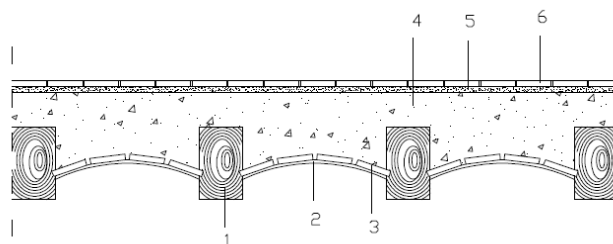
, Ejemplo de viga intermedia. Fuente: Propia
